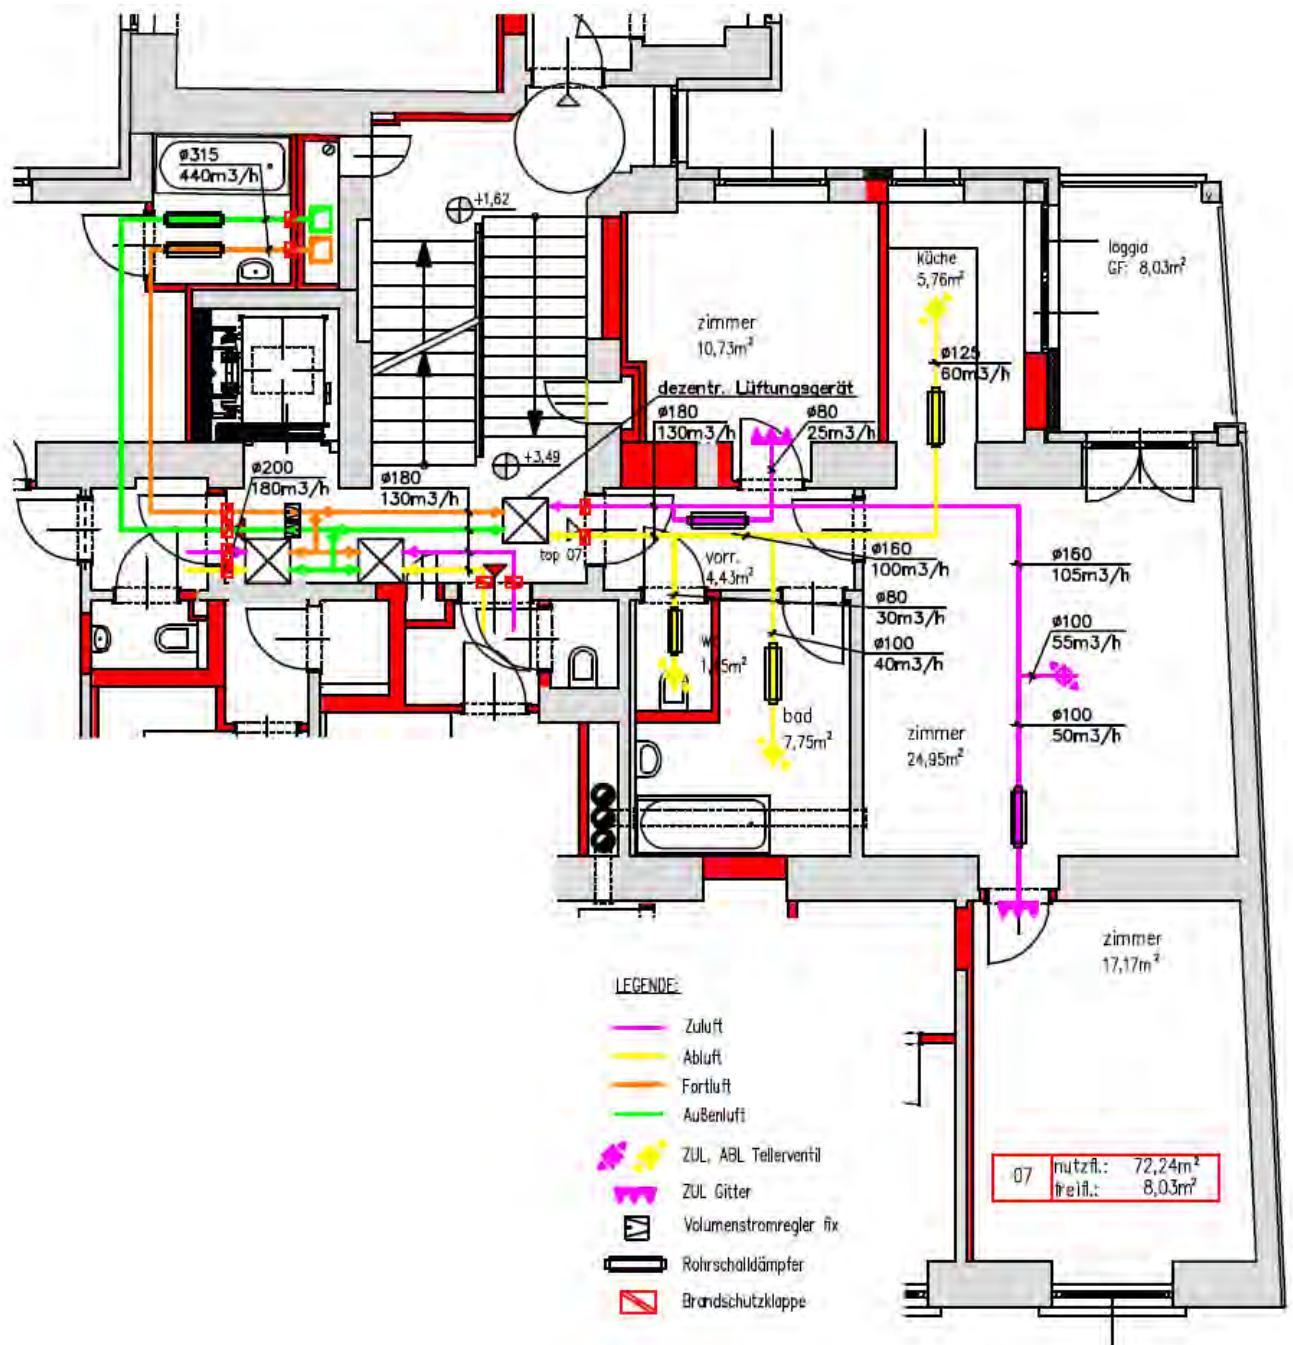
Grundrissdarstellung semidezentrale Lüftung
